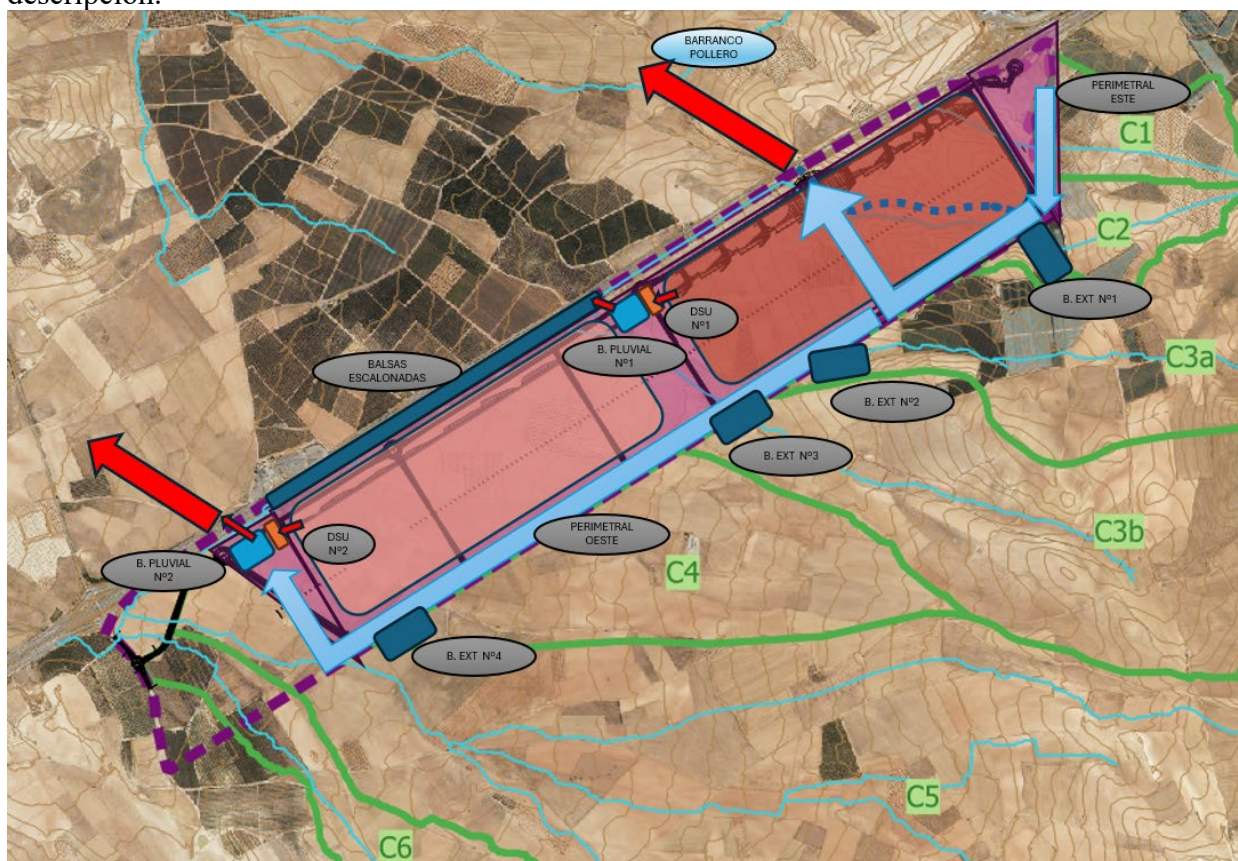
Esquema general de drenaje en situación futura. En azul cielo las balsas de captación perimetral y en azul oscuro las balsas para laminación.
